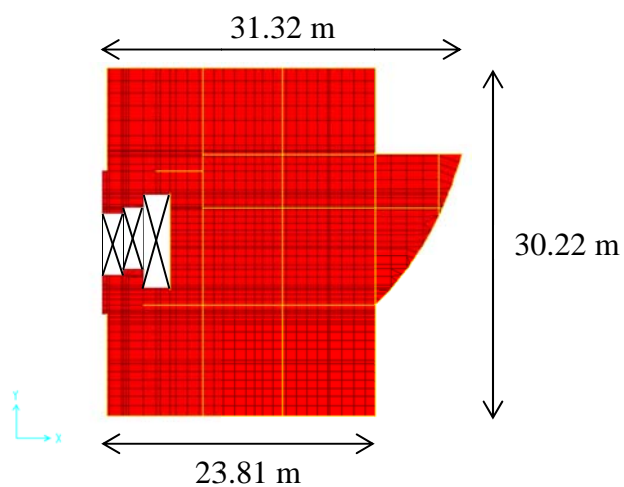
Dimensiones de la Planta Cielo Piso Tipo del Tercero al Duodécimo (S/E).
